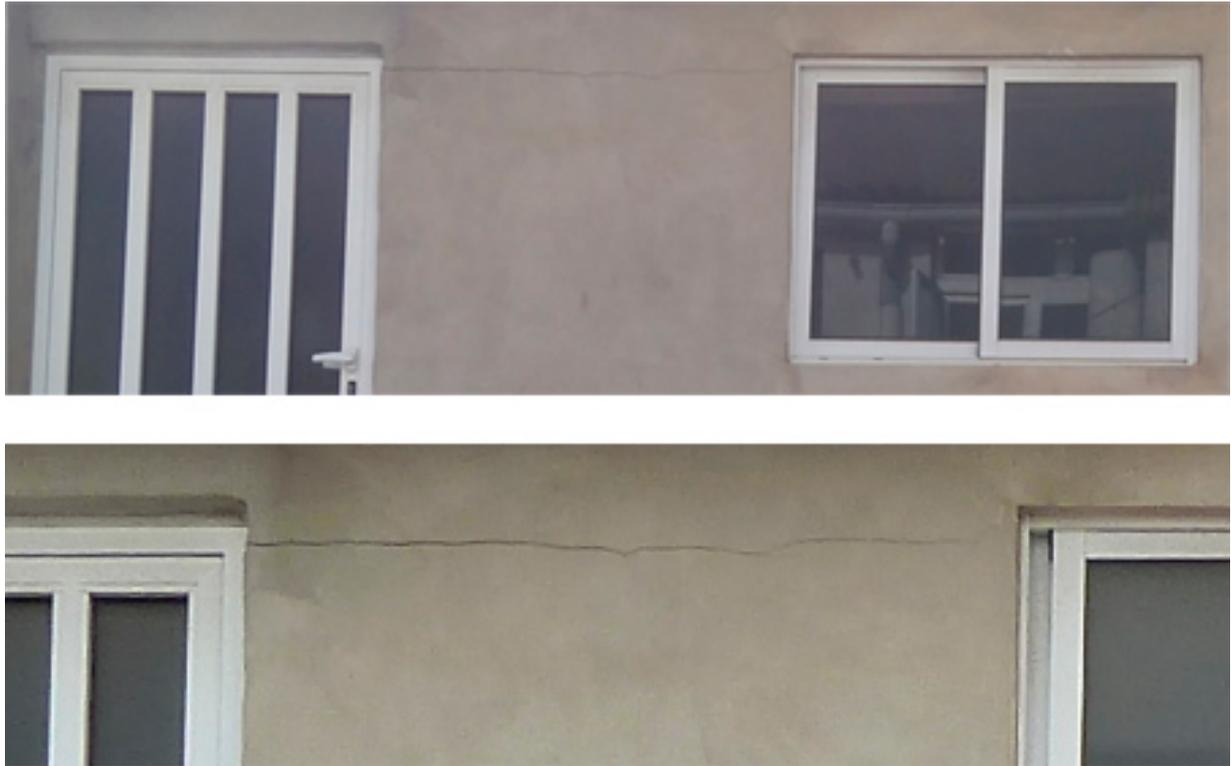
Fotografía detalle de grieta en fachada cuerpo anexo. Fuente propia
